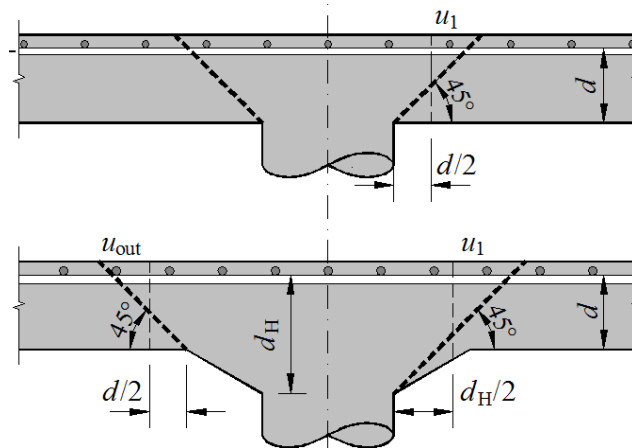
Teoria da fissura crítica para lajes com capitéis
